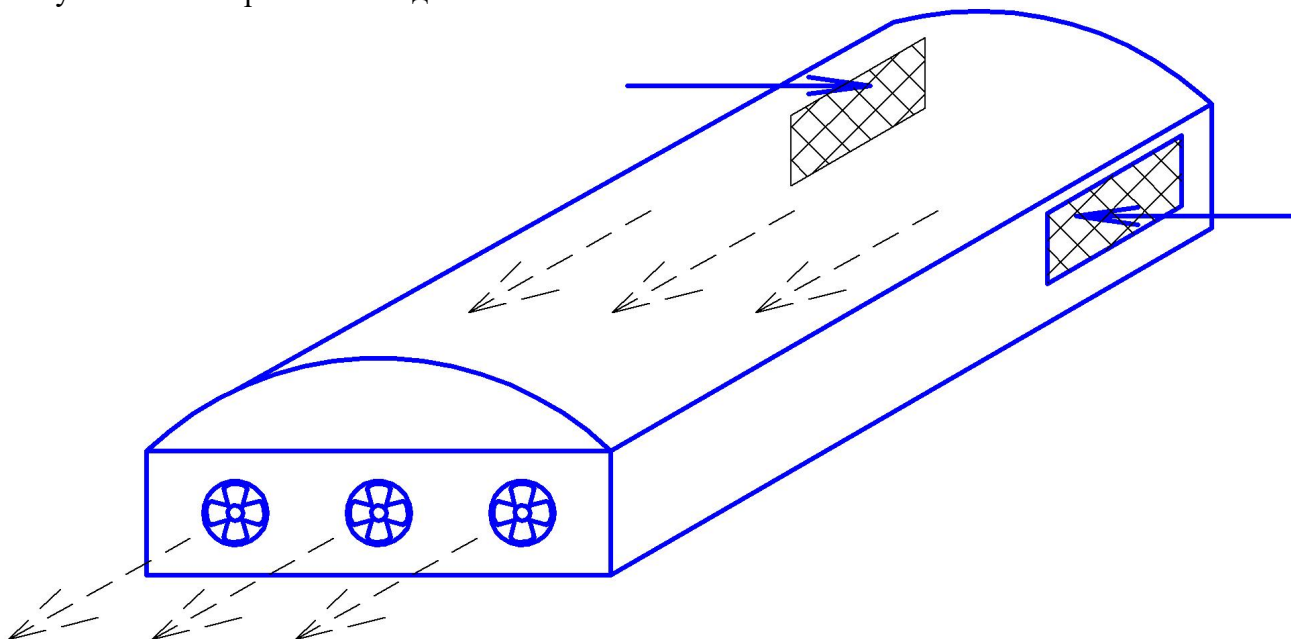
Тоннельная вентиляция с системой кондиционирования воздуха
